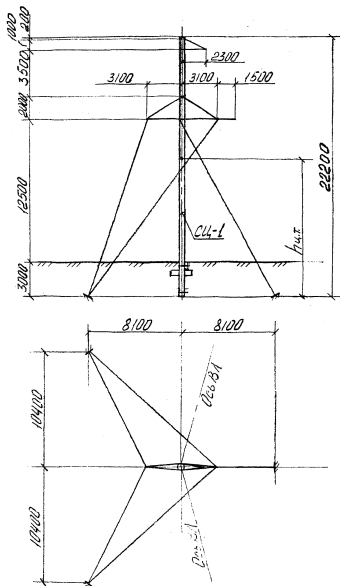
Эскиз одностоечной железобетонной опоры типа ПУСБ 110-1
